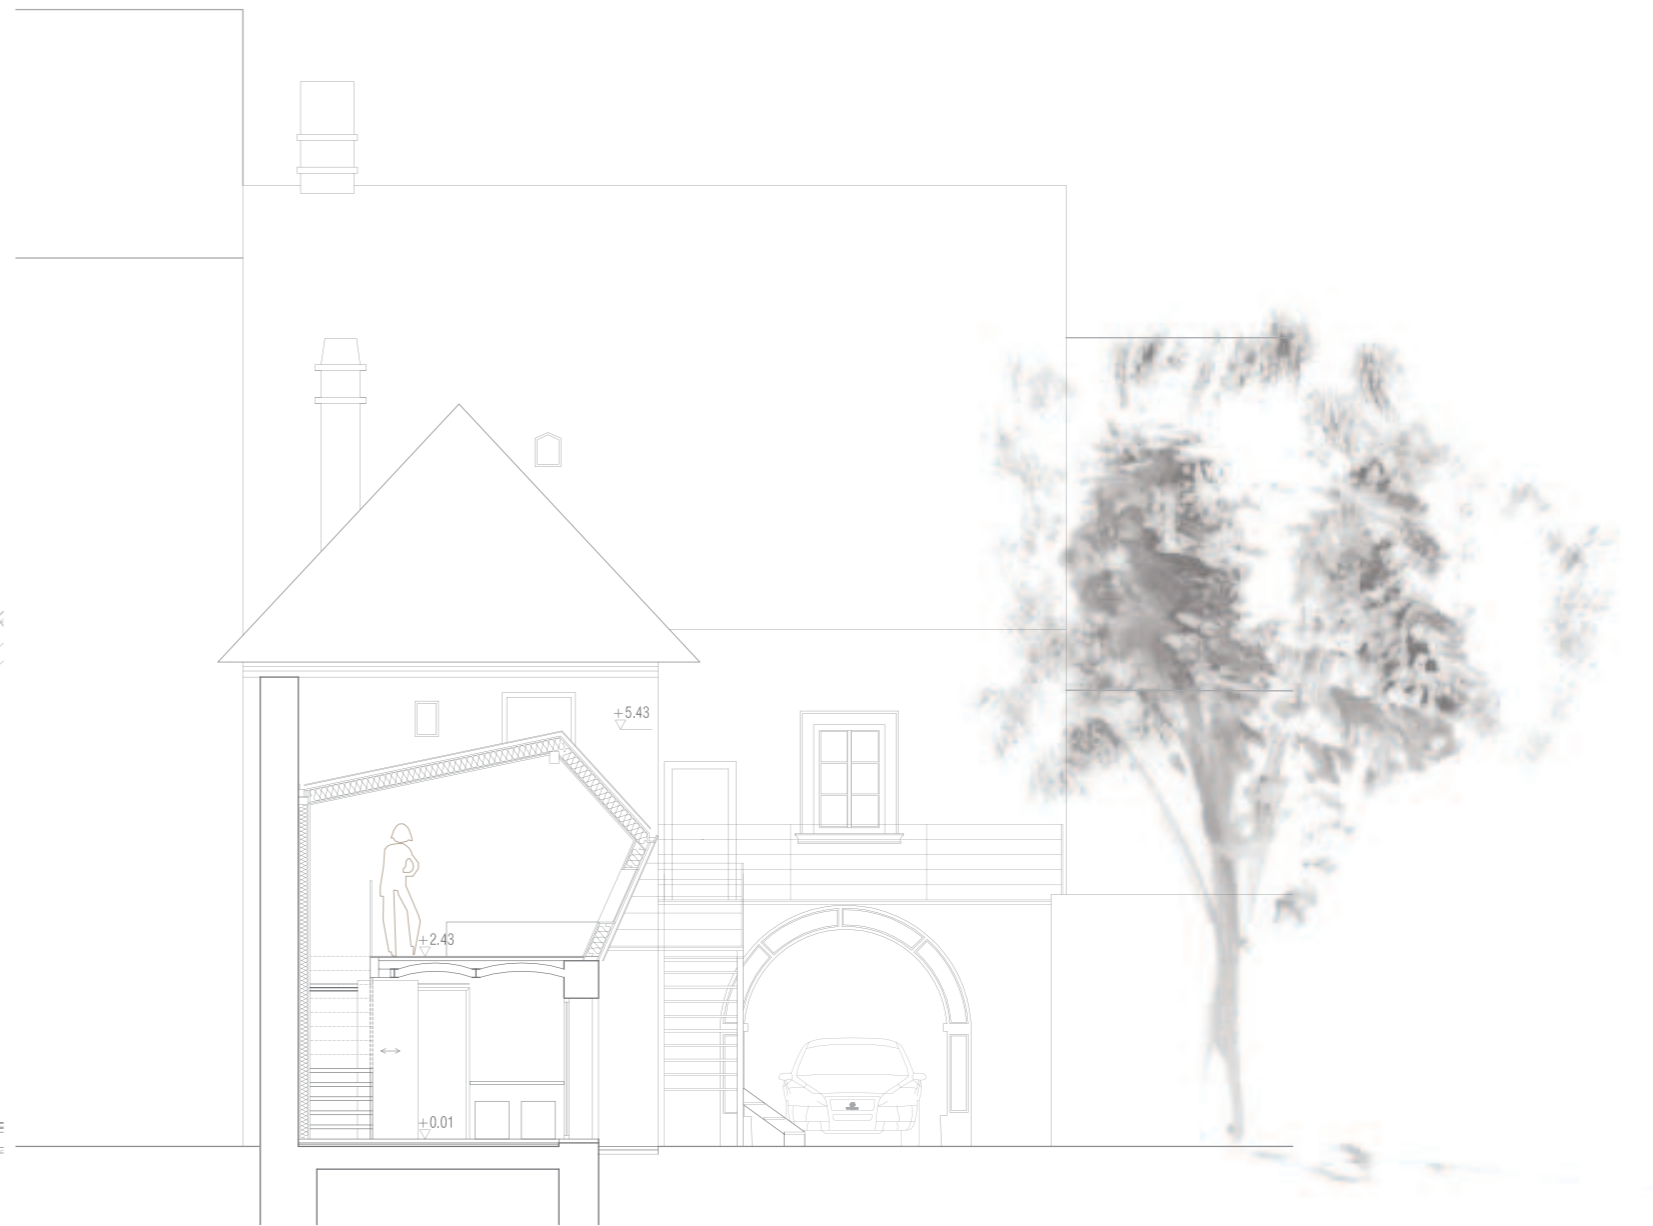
Gebäude B_GÄSTEHAUS_Schnitt DD Maßstab 1:100
